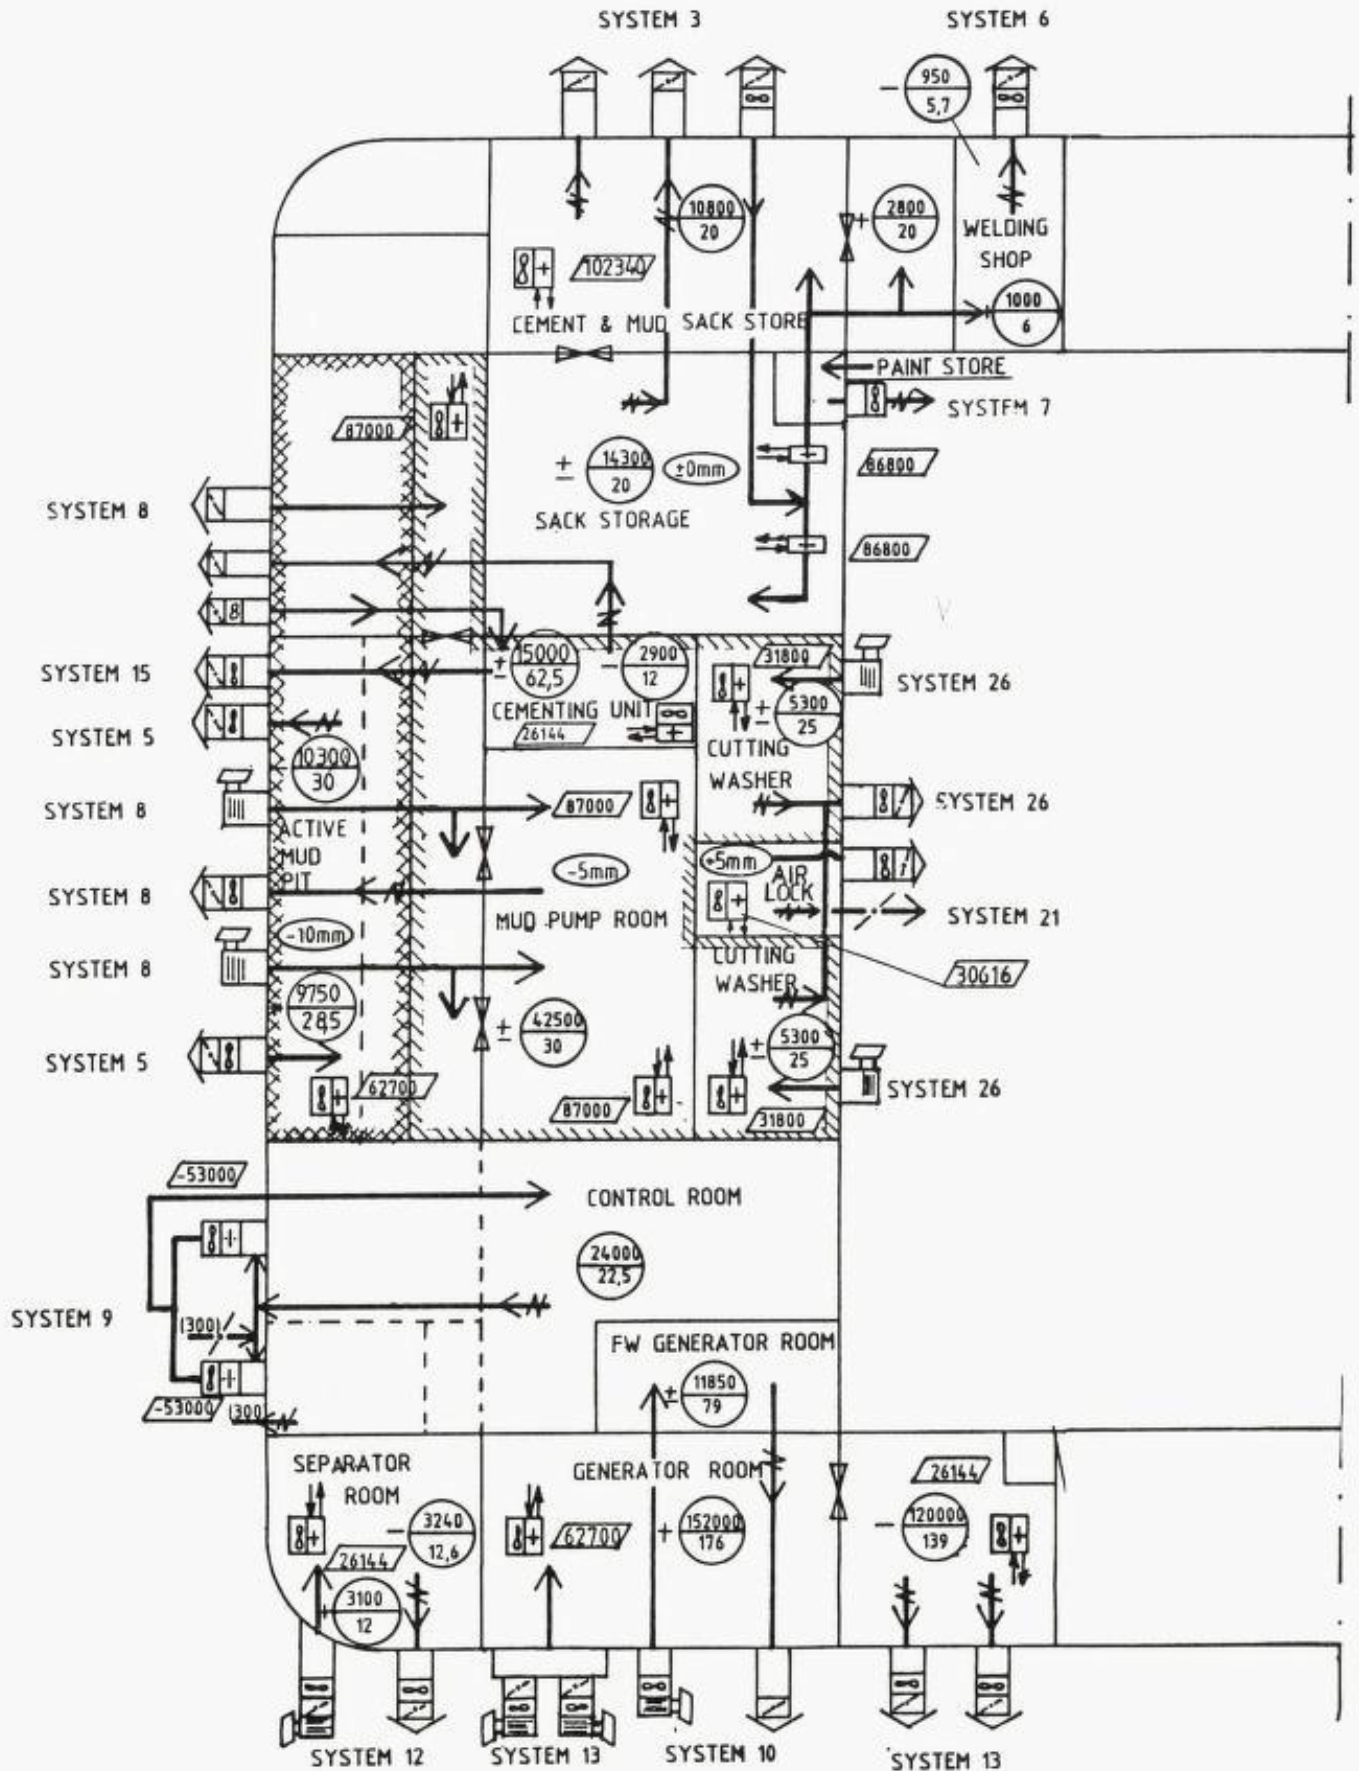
Plan over ventilasjonssystem på akre Main Deck.
